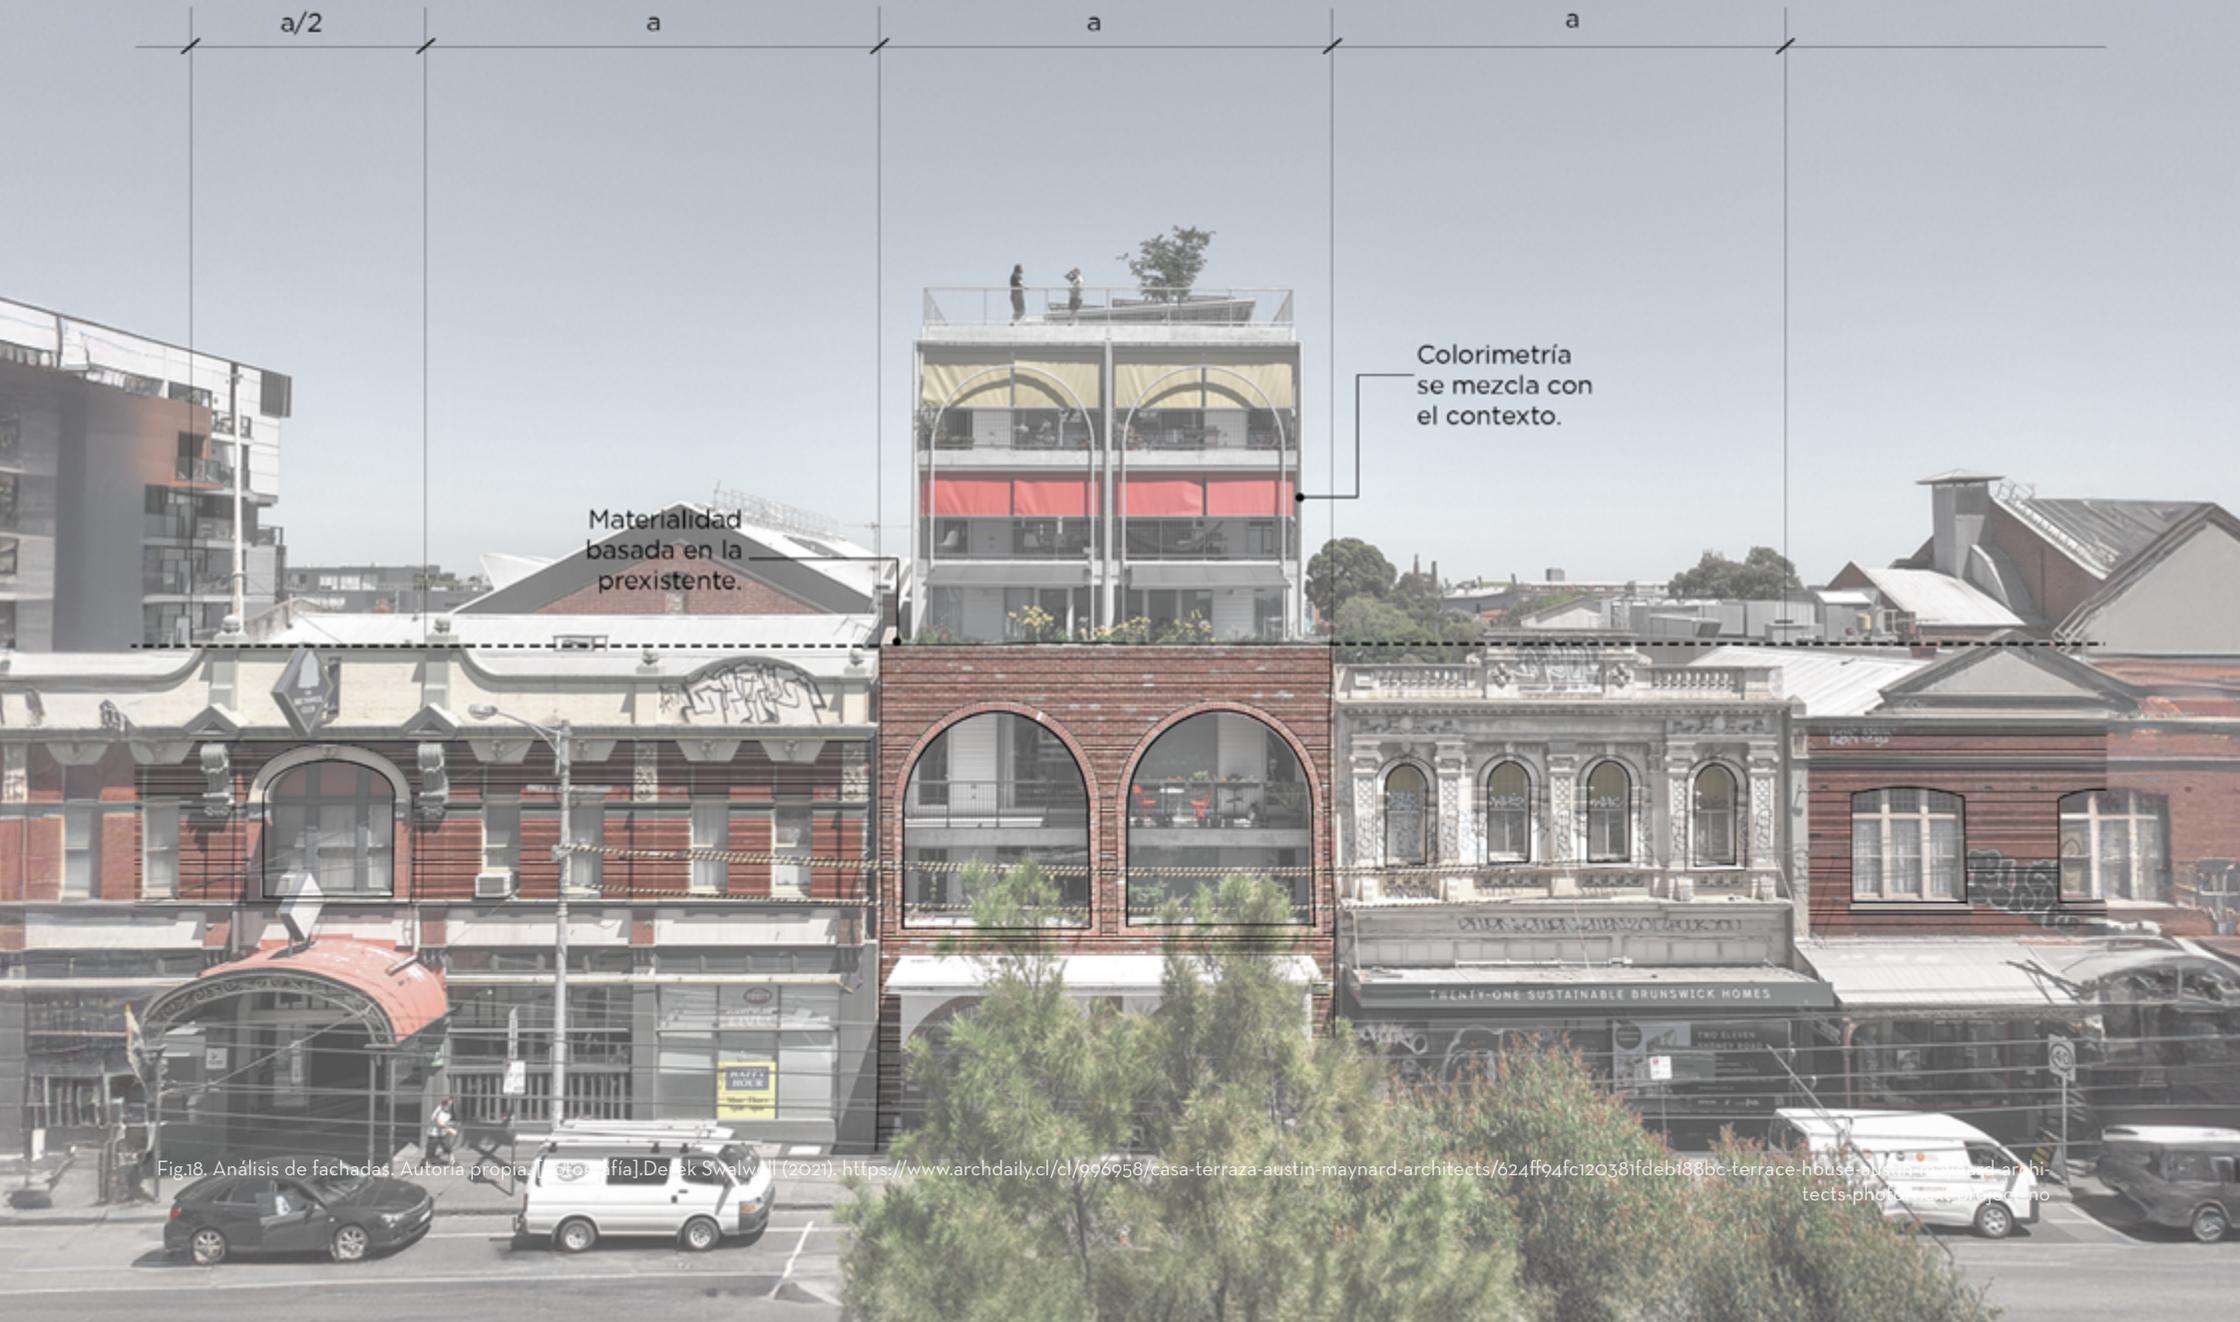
Análisis de fachadas. Autoría propia. [Fotografía] Derek Swalwell (2021). <https://www.archdaily.cl/cl/996958/casa-terrazza-austin-maynard-architects/624ff94fc120381fdeb188bc-terrace-house-austin-maynard-architects-photography-proyecto-no>
